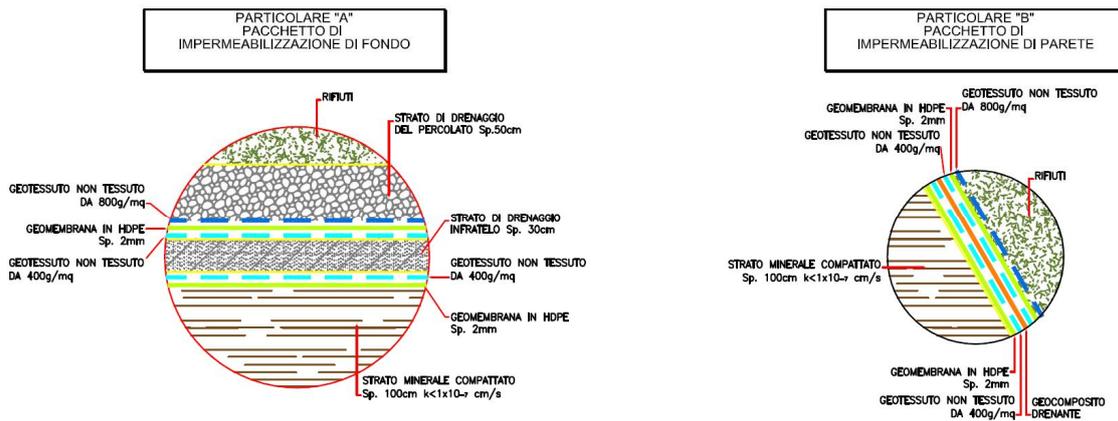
Particolare A e B Pacchetto di impermeabilizzazione Fondo e Parete
